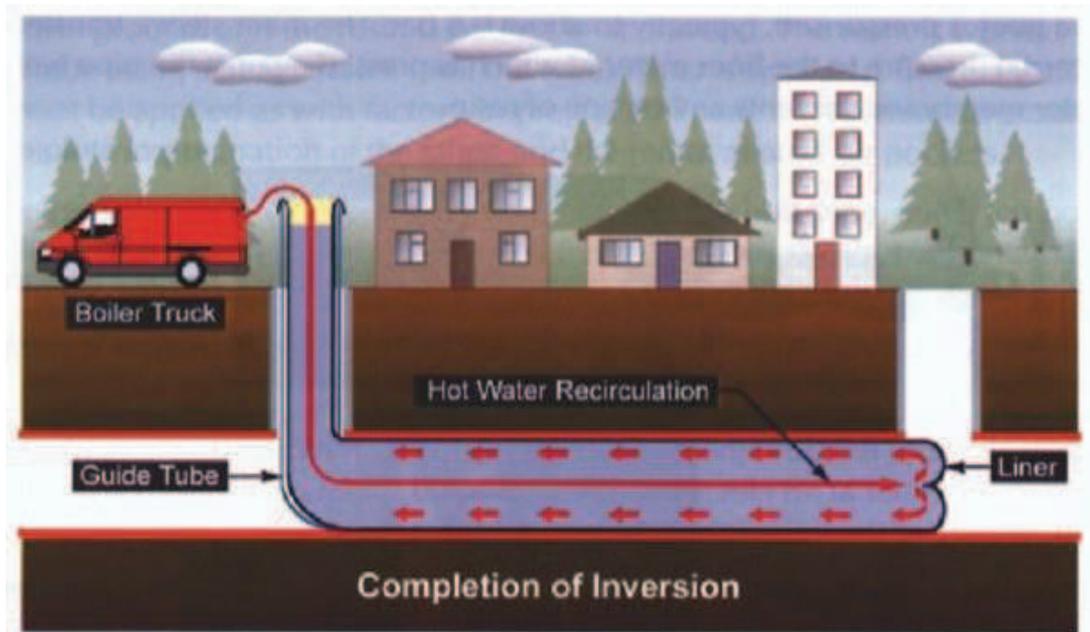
CIPP (Cured in Place Pipe) – Tubería polimerizada en sitio, Fuente: PAVCO, 2010
